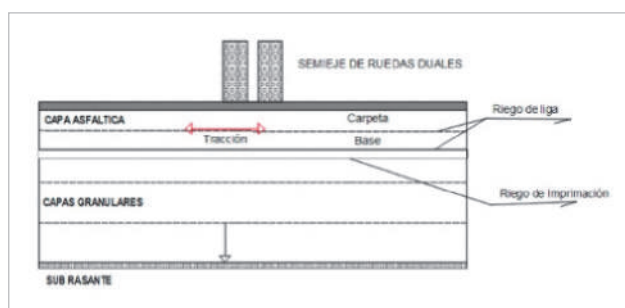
Ubicación de riego de liga dentro del paquete estructural
